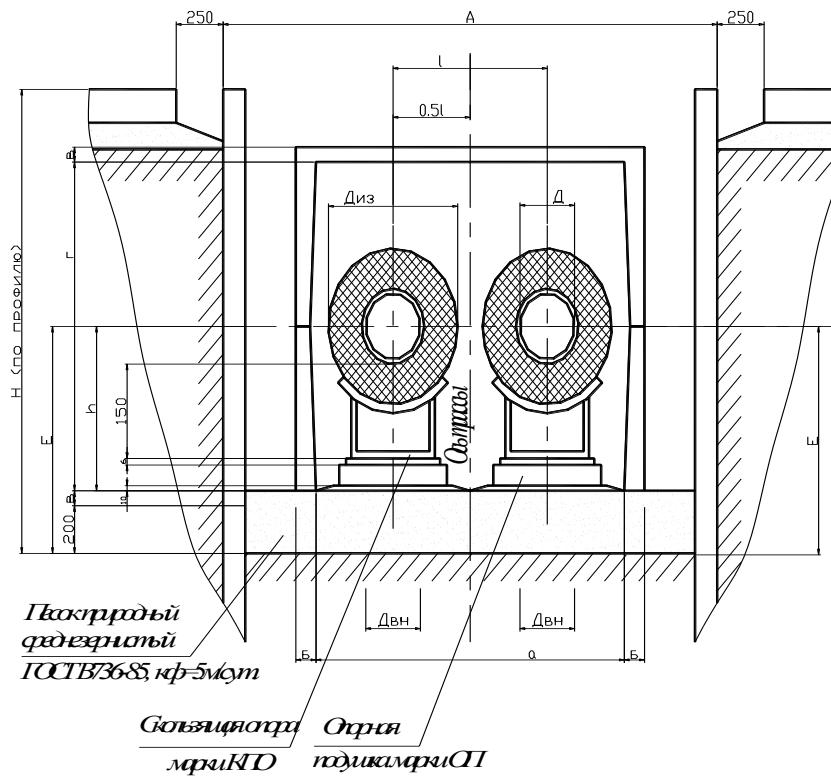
Канальная прокладка теплопроводов в ППМ изоляции без устройства продольного дренажа.
